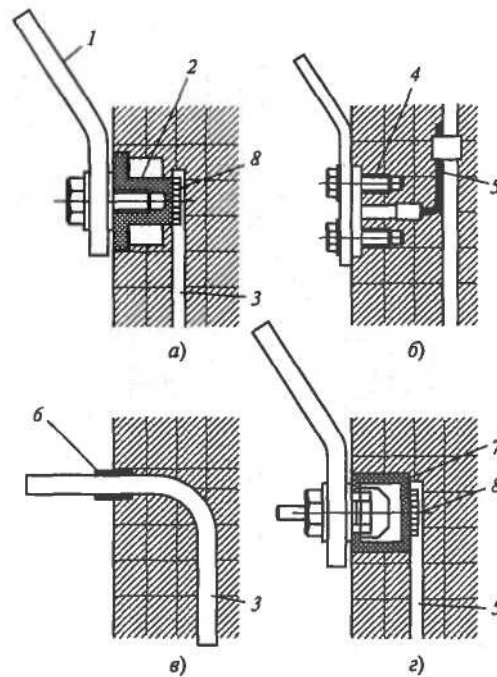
Примеры присоединения к арматуре железобетонных стен:
